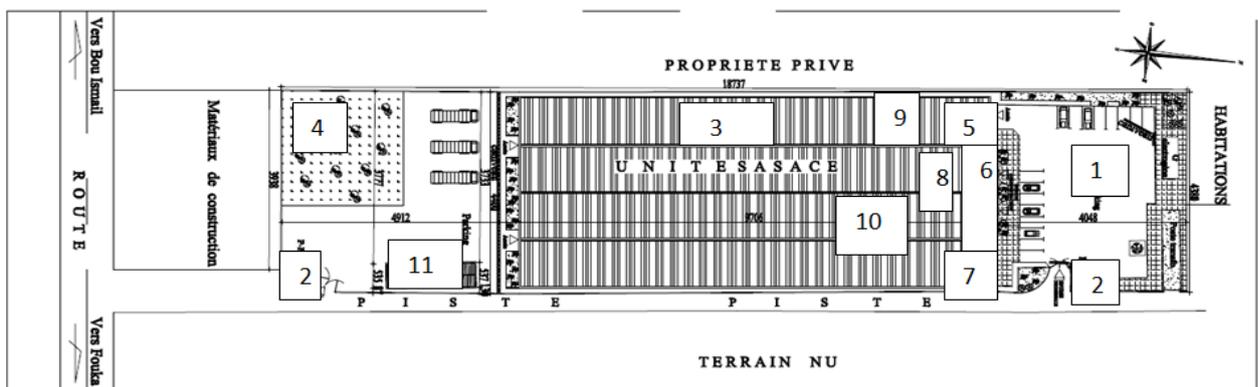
Le plan de masse de l'usine (SASACE, 2014)
